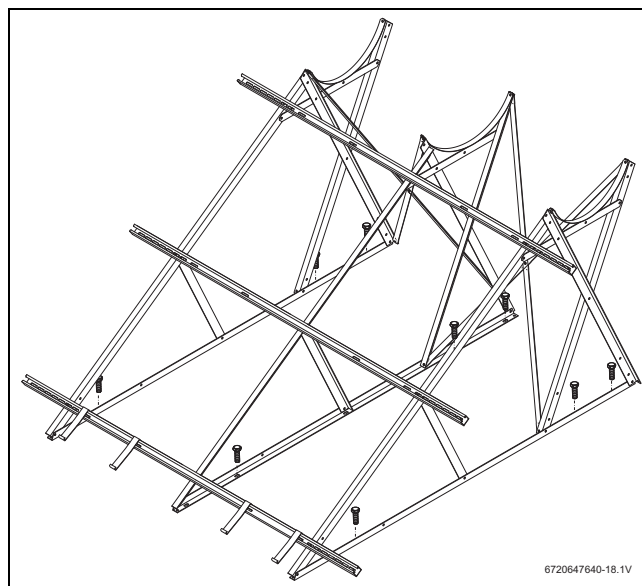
Soporte para tejado plano - anclaje directo en el tejado (sistema de 300 I)
